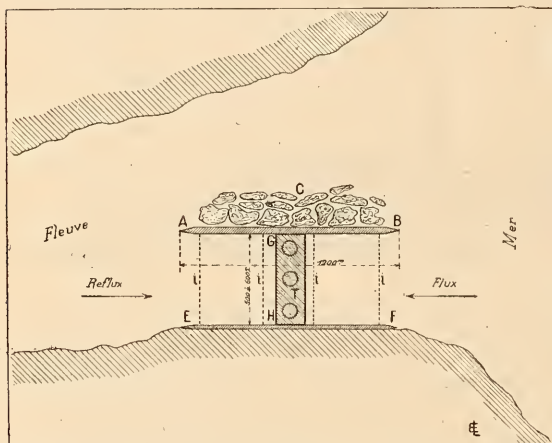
Plan d'une installation à l'estuaire d'un fleuve.
